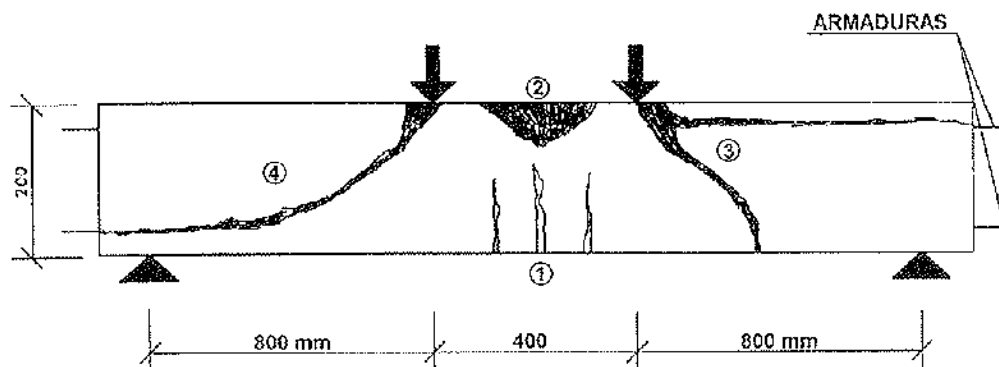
Esquema de los tipos de rotura en vigas con armaduras corroídas.
